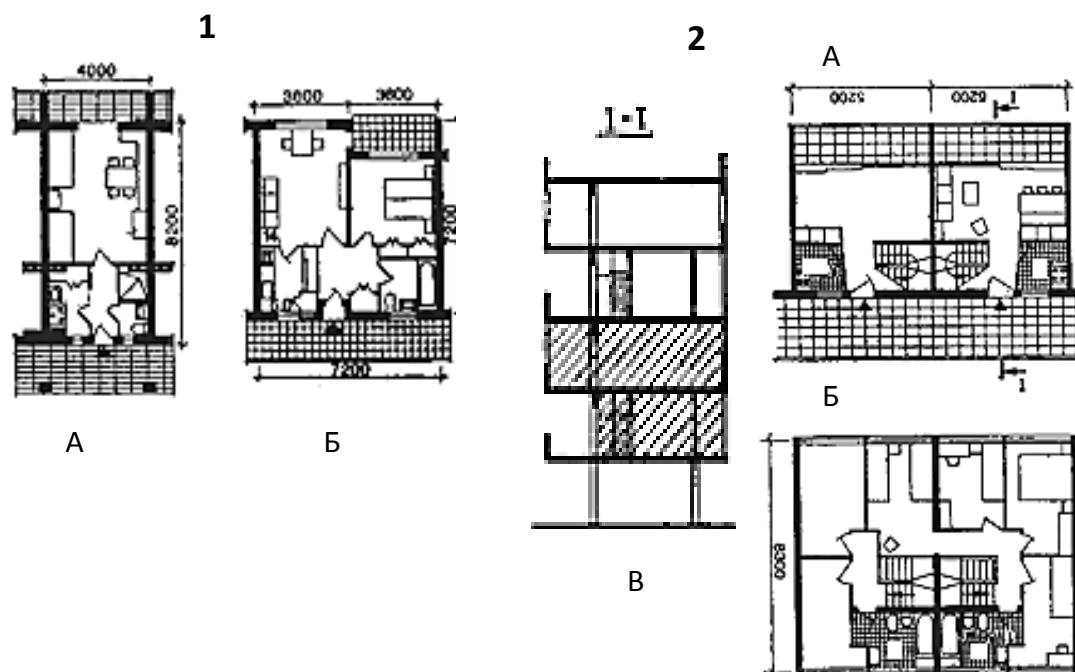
1. Планировочные решения квартир в галерейных домах. 2. Галерейный дом с галереями, расположенными через этаж (квартиры в двух уровнях). А- план квартиры на втором уровне; Б – план квартиры на первом уровне; В – разрез.
